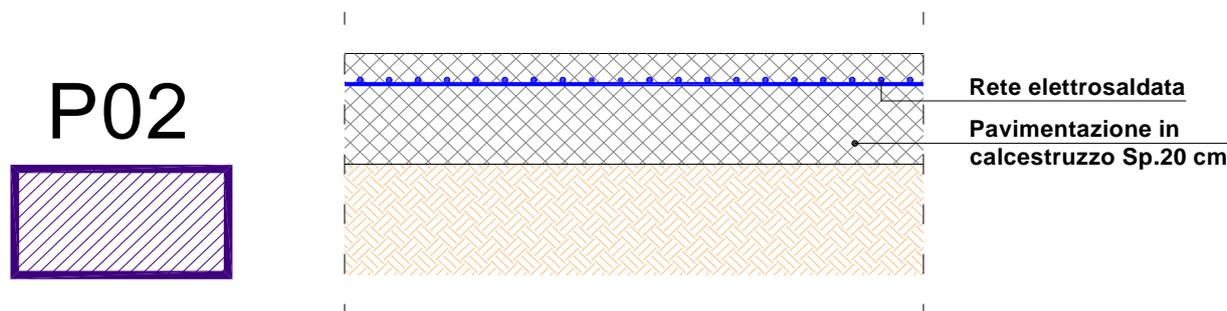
Interventi di pavimentazione tipo P02 – Nuove pavimentazioni in calcestruzzo.
